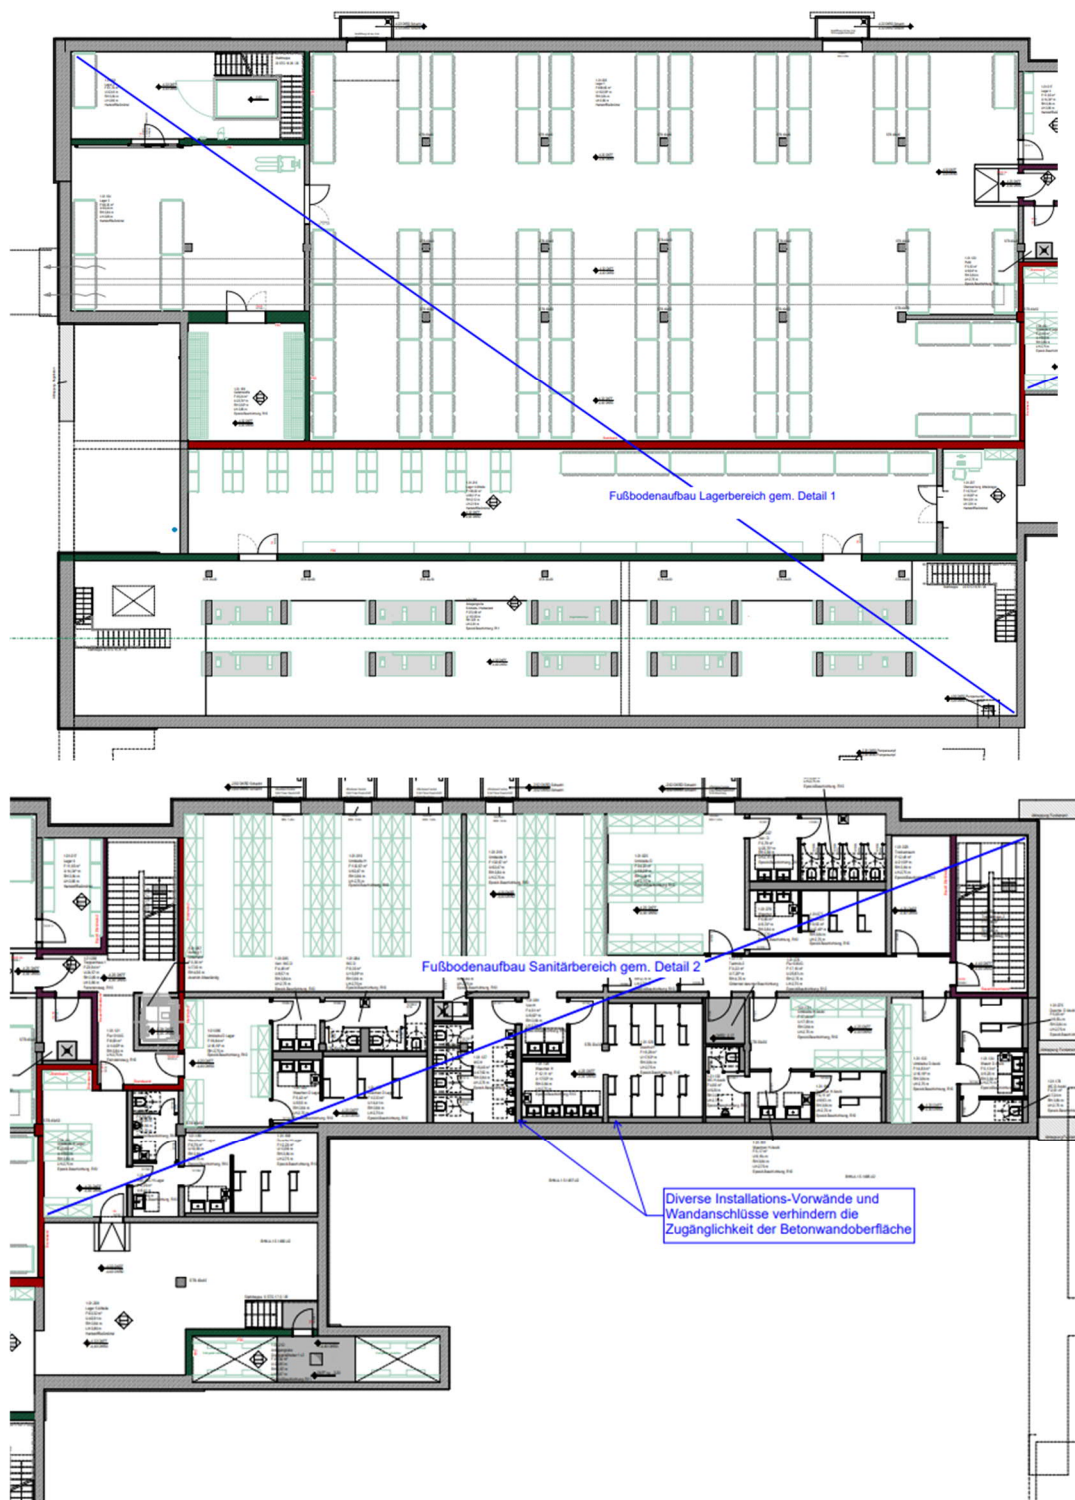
Übersicht Fußbodenaufbauten und Zugänglichkeit
